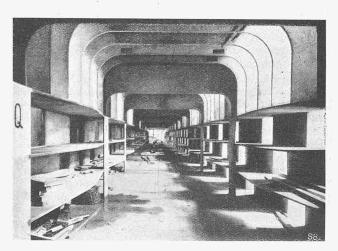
Betonwände mit Tablaren im Schalthaus (im Bau).
